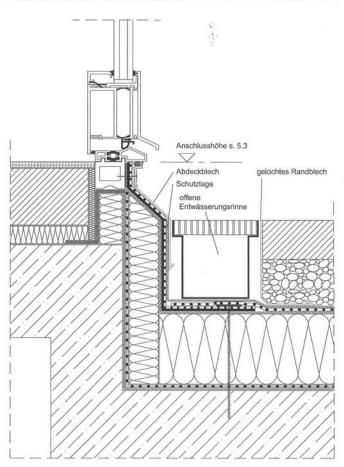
Terrassentüranschluss mit Entwässerungsrinne – Ausführung mit Kunststoffbahnen und Verbundblech
